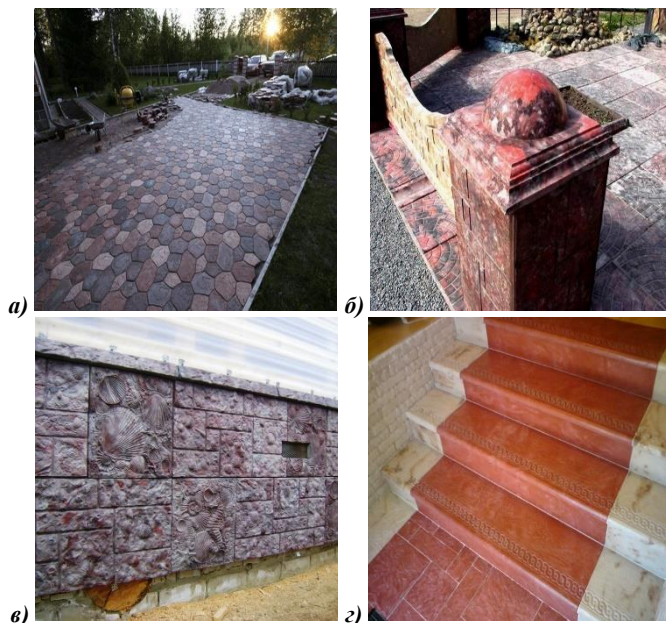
Примеры применения кевларобетона: а – плитка для тротуаров; б – секция ограждения; в – отделка цокольного этажа; г – лестничный марш;
